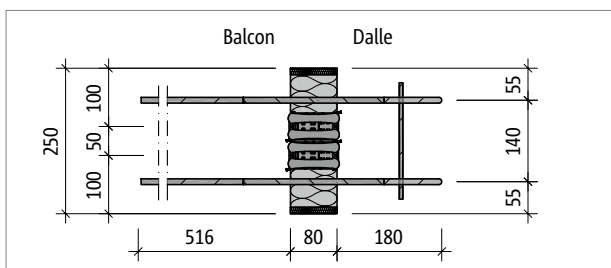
Schöck Isokorb® T Type Q-E-W-V5-L250 : Plan de base du produit
